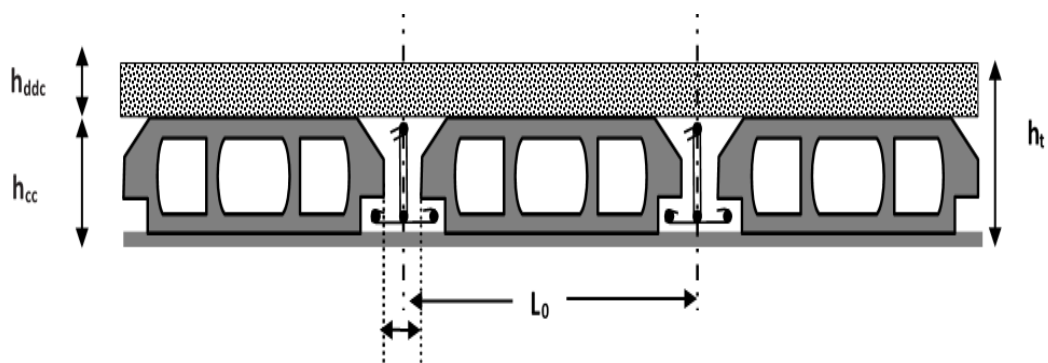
Coupe transversale sur un plancher à corps creux.
